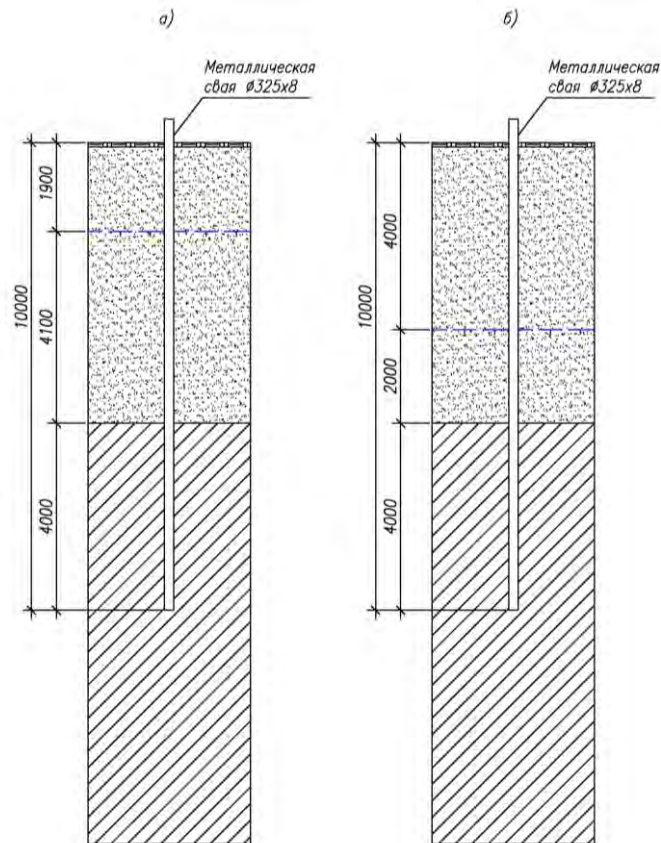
Расположение сваи фундамента длиной 10 м в грунте
